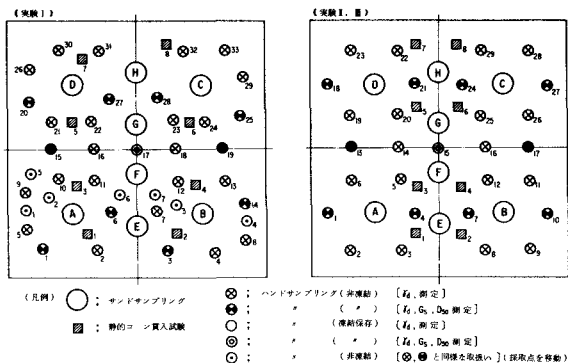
不攪乱試験の静的コーン貫入試験の平面配置図
